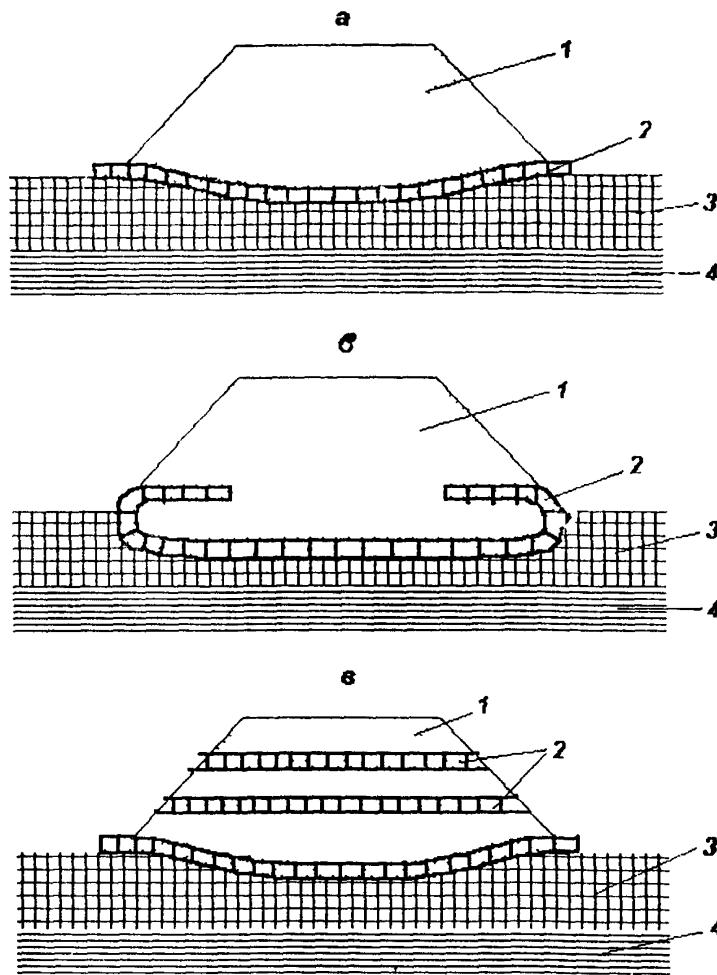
Применение «Геовеба» при устройстве насыпей на болотах без выторфовывания а – с армирующей прослойкой в основании, б – с полуобоймой в основании, в – с прослойкой в основании и армирующей прослойкой по высоте, 1 – песок насыпи, 2 – «Геовеб» с заполнителем, 3 – торф, 4 – минеральное основание
